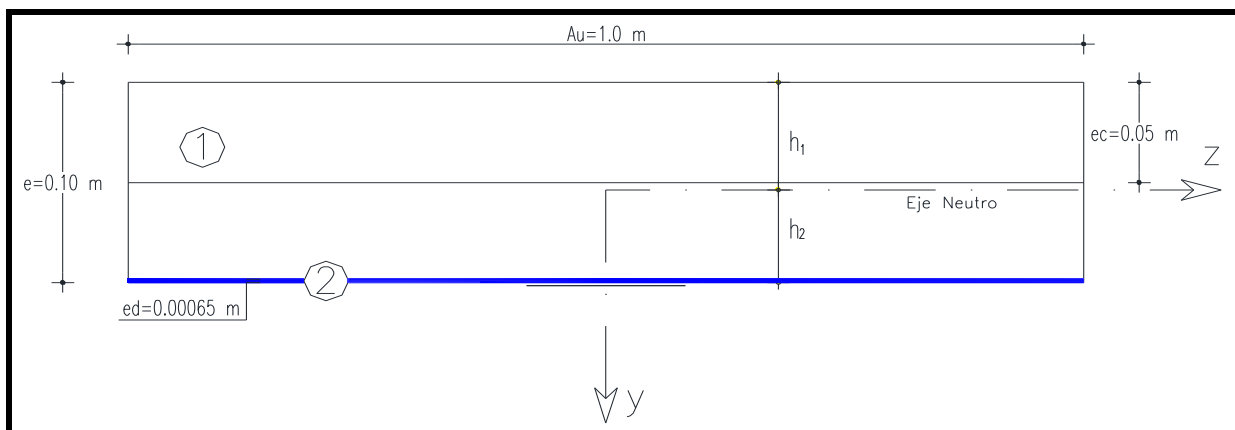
INERCIA SECCION LOSA DECK.
